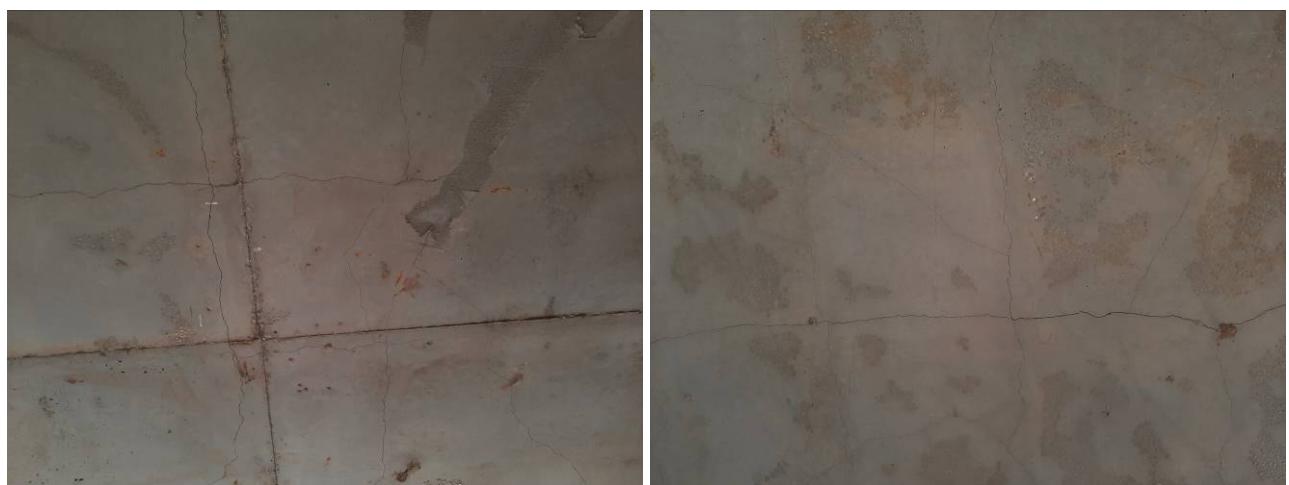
, 40 Растрескивания плиты перекрытия на отметке +5900.
